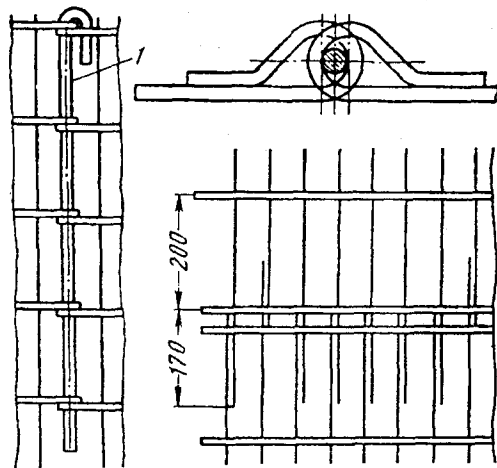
Стальная решетчатая затяжка МРЗ конструкции ЦНИИподземмаша
